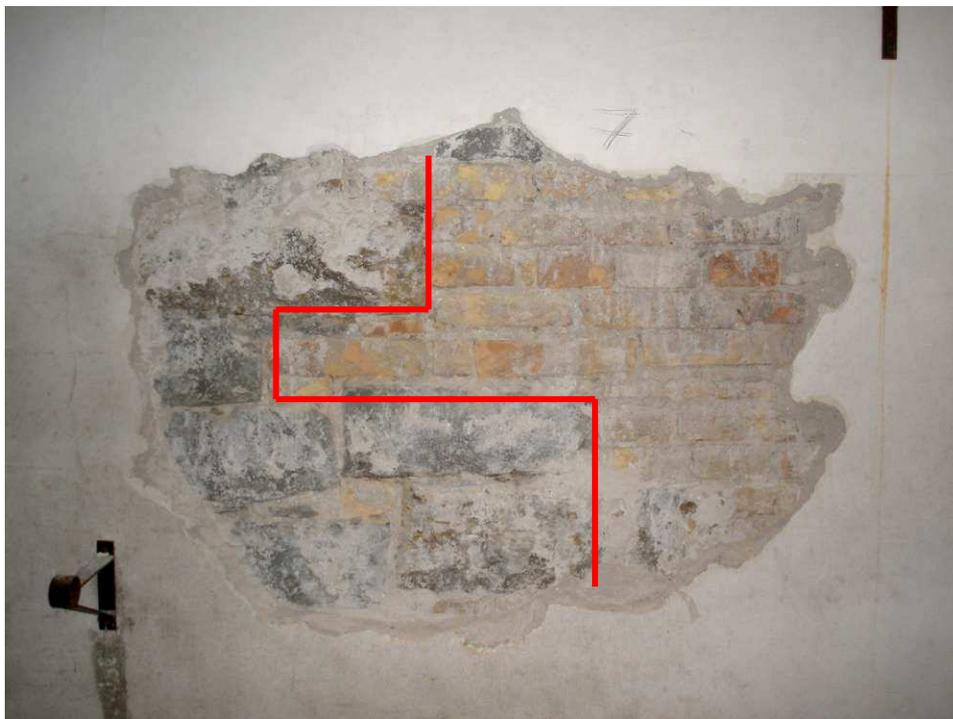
SONDAGGIO 7A - parete in cui si evidenzia una sezione di collegamento tra la parete in pietra (con uno strato di intonaco 3cm) e la parete in mattoni pieni (strato di intonaco 3cm).
